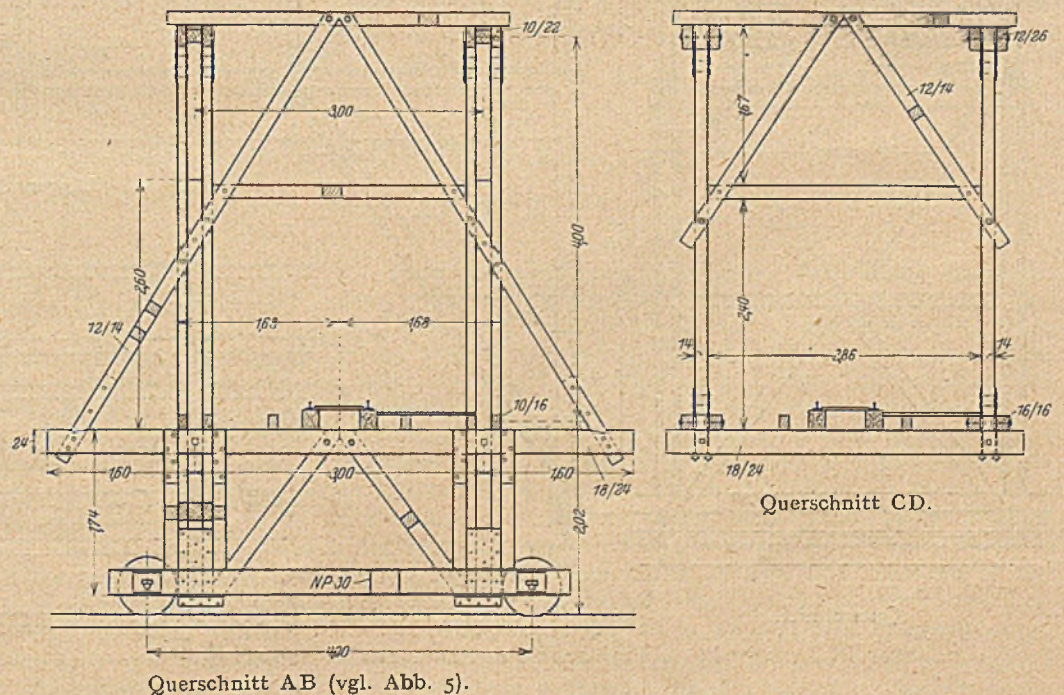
Querschnitte der Betonierbrücke in Stettin.
